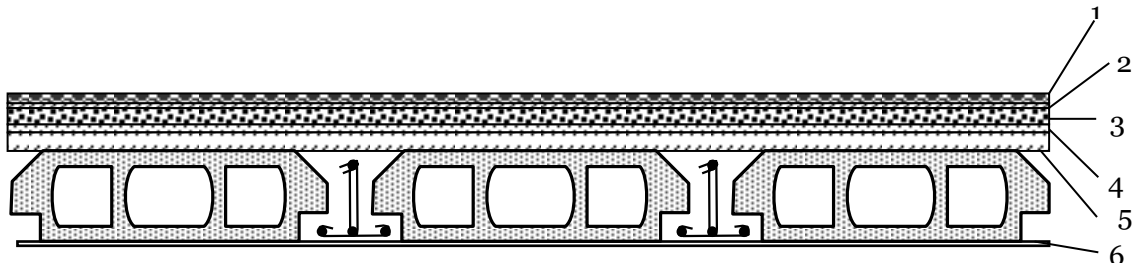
a: Composants d'un plancher terrasse en corps creux (inaccessible)
